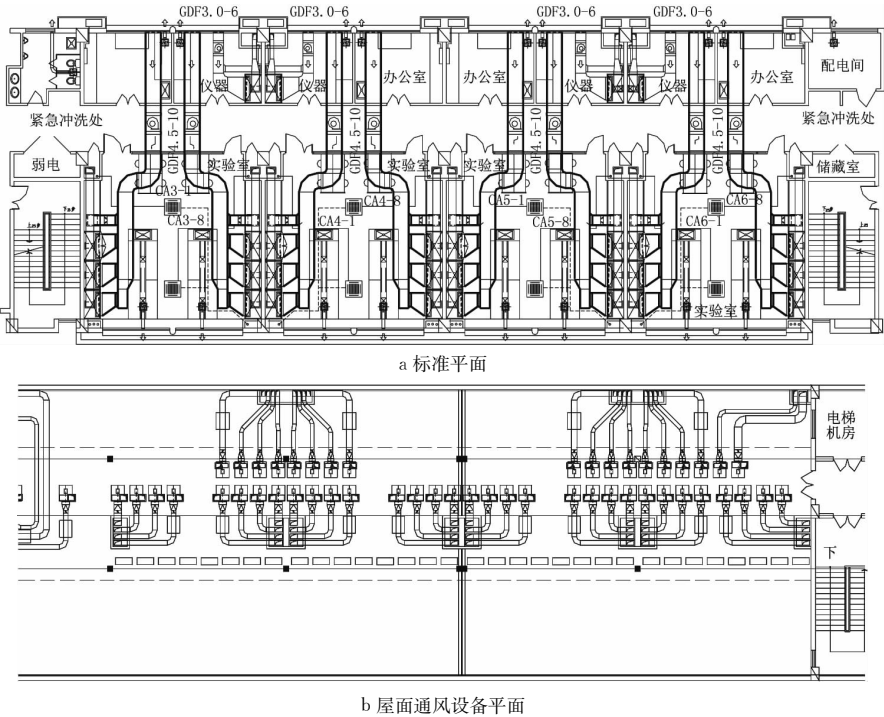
传统的5层实验大楼标准平面及屋面通风设备平面图
